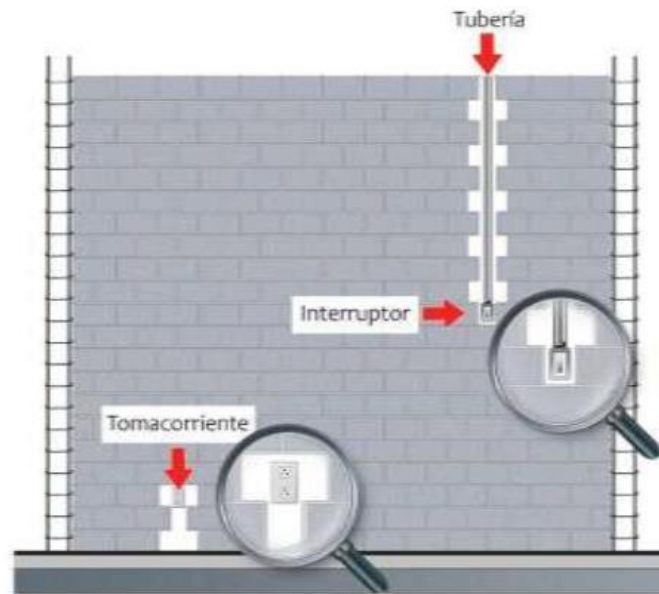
Conexiones eléctricas en las paredes de mampostería Confinada
